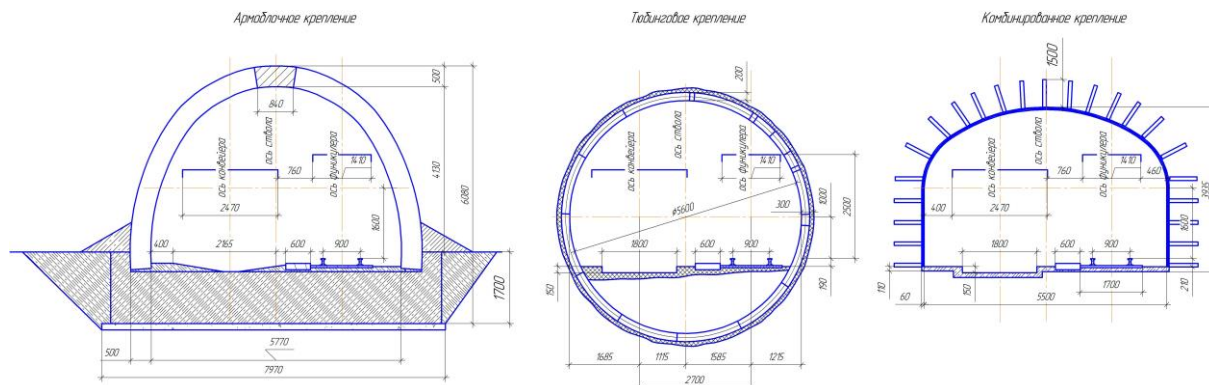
Форма сечения и типы крепления капитальных наклонных горных выработок
